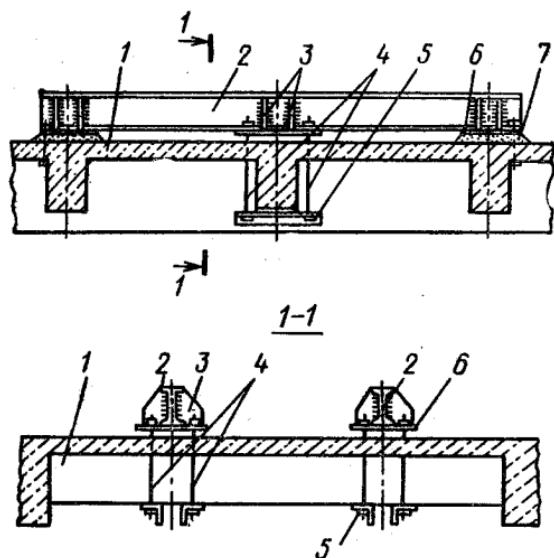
Усиление балки и плиты перекрытия металлическими балками сверху:
